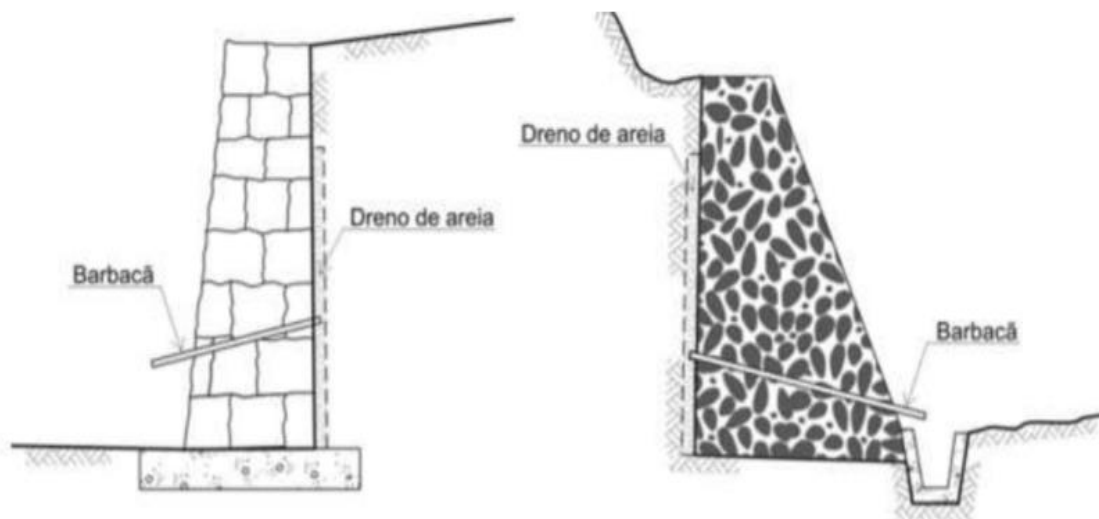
Muro de alvenaria de pedra (GEO-RIO, 2014)
